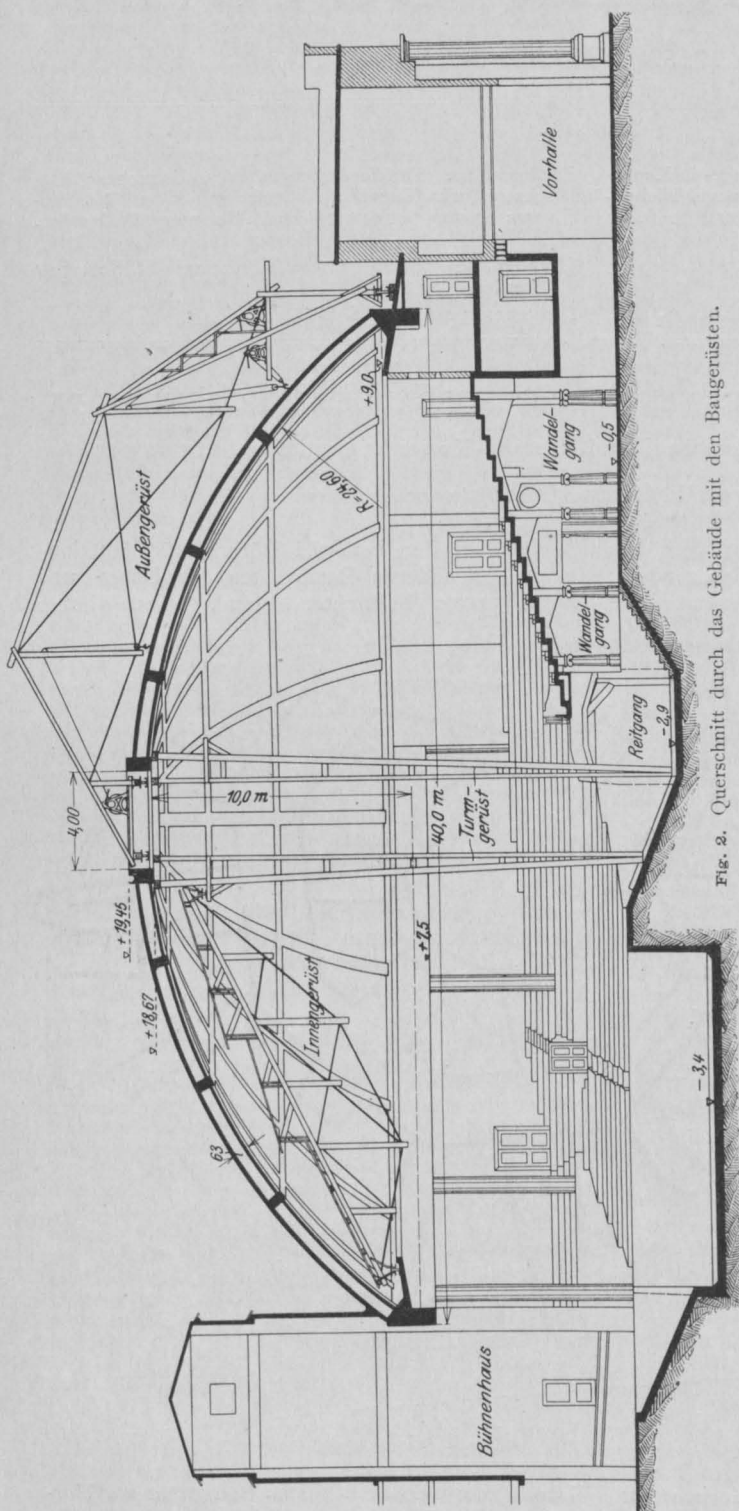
Querschnitt durch das Gebäude mit den Bangerüsten.
